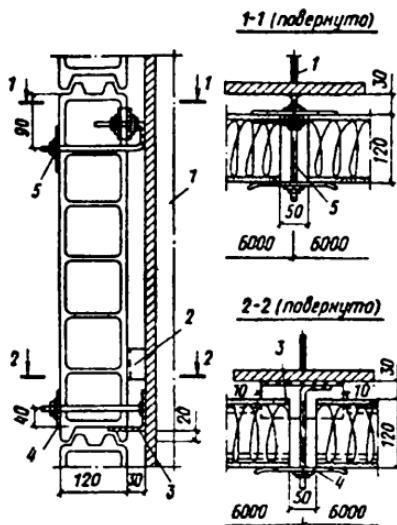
Крепление стеновых экструдиционных панелей к колонне или стойке фахверка:
